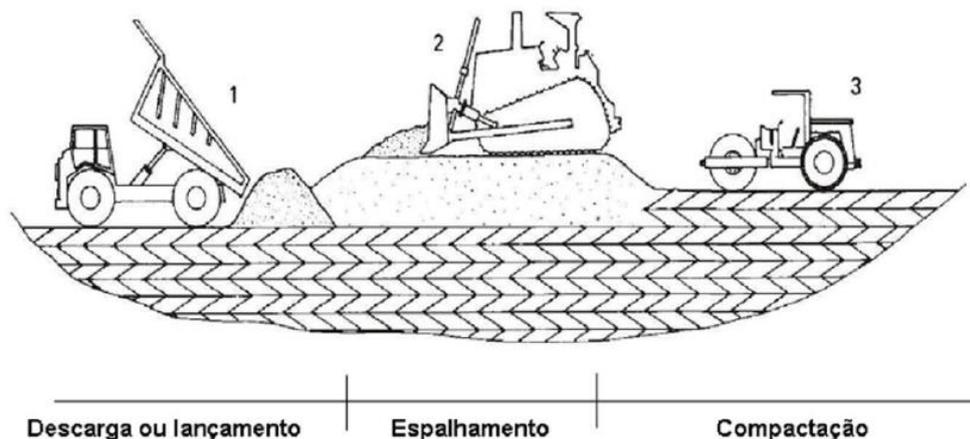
Exemplo do faseamento construtivo de construção de aterro.
